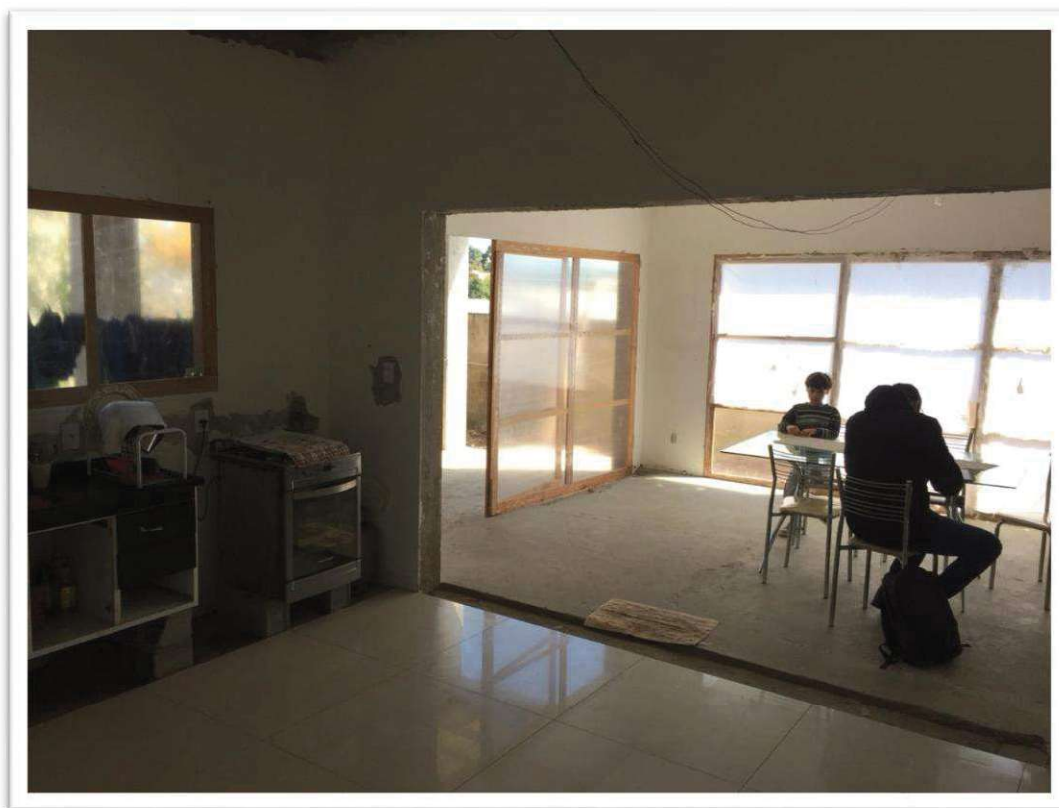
COZINHA VISTA 02 - PISO TÉRREO
